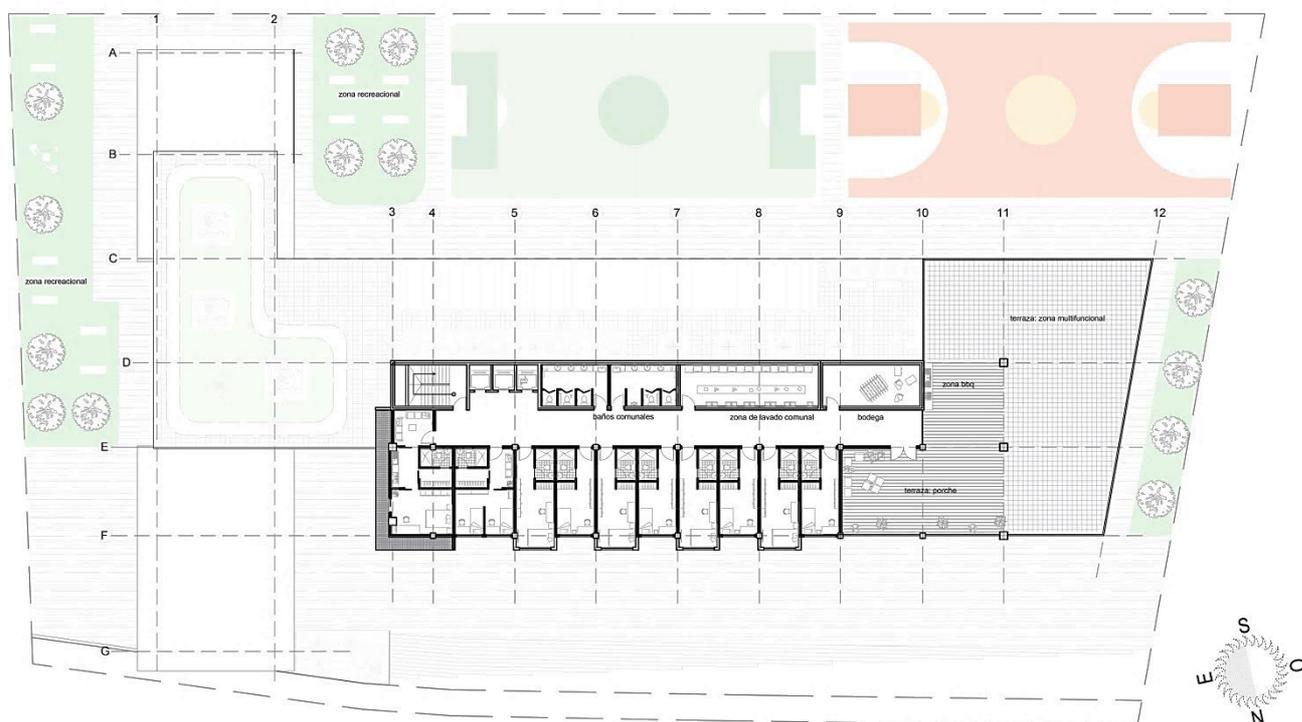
Planta: piso 7 Cevallos. (2018). Creación propia
